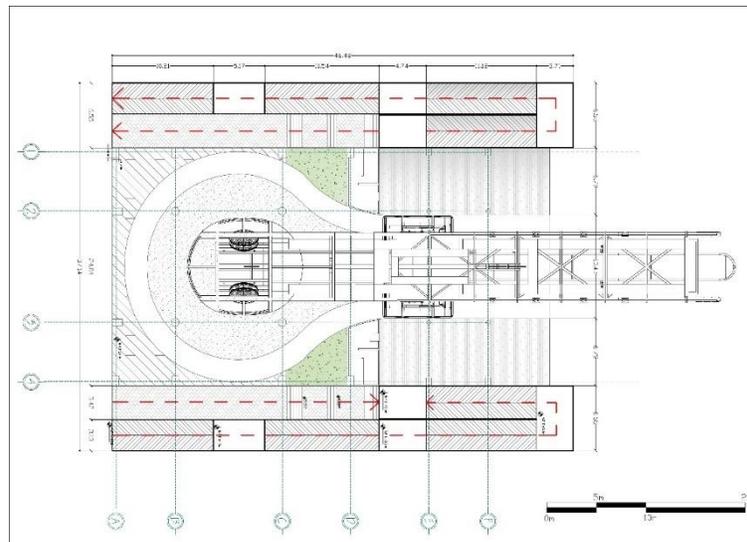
Vista en Planta estación de Teleférico propuesto
